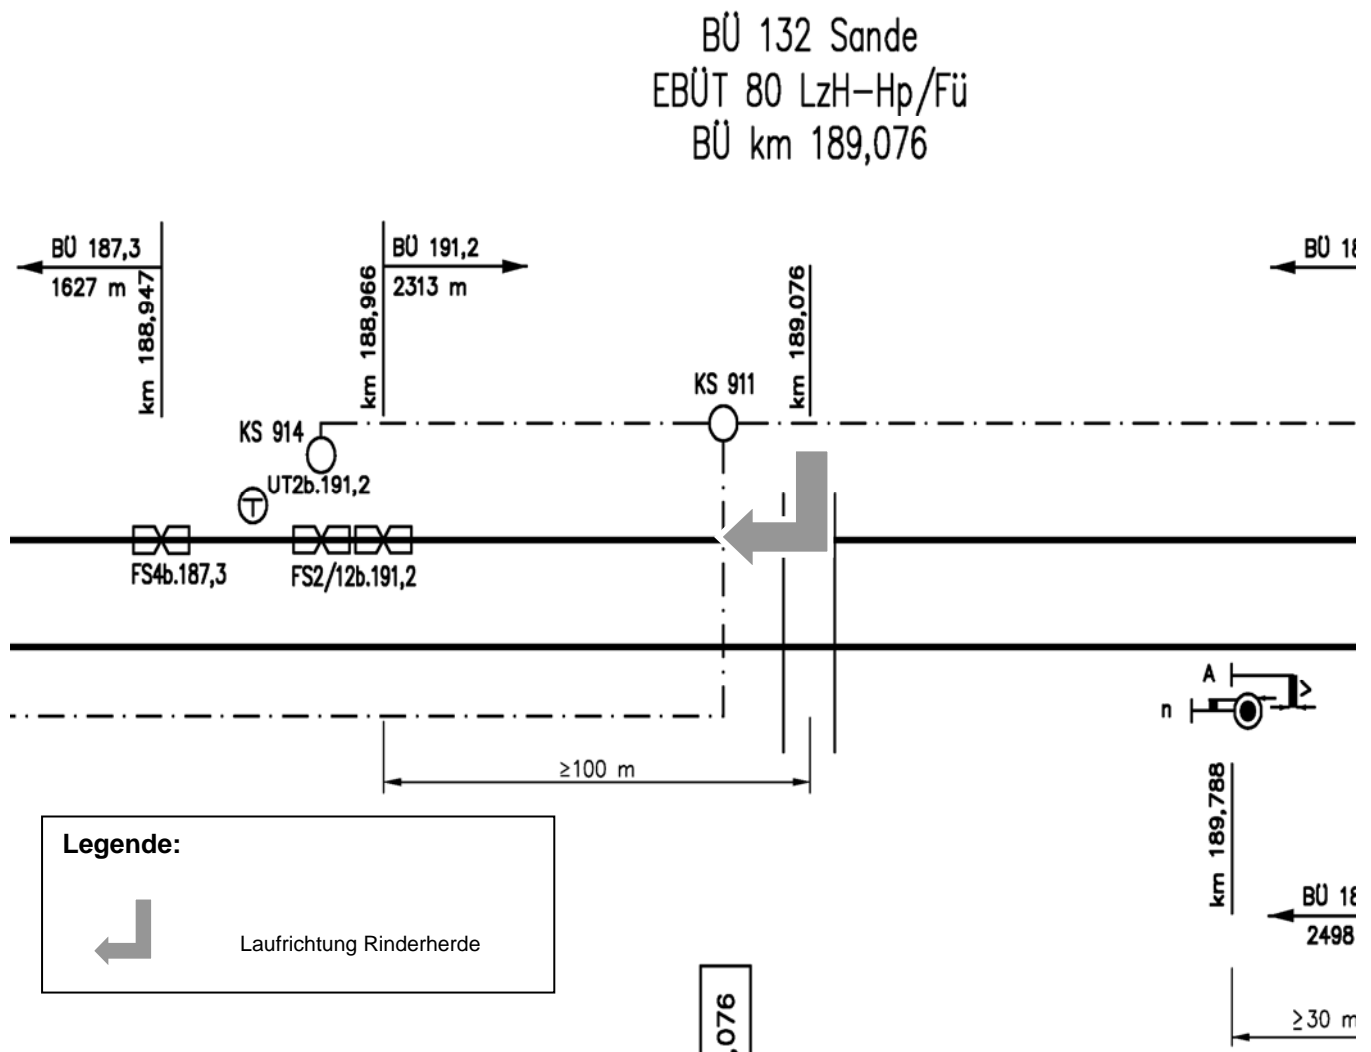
Auszug aus dem Streckenplan – BÜ 132 Sande
